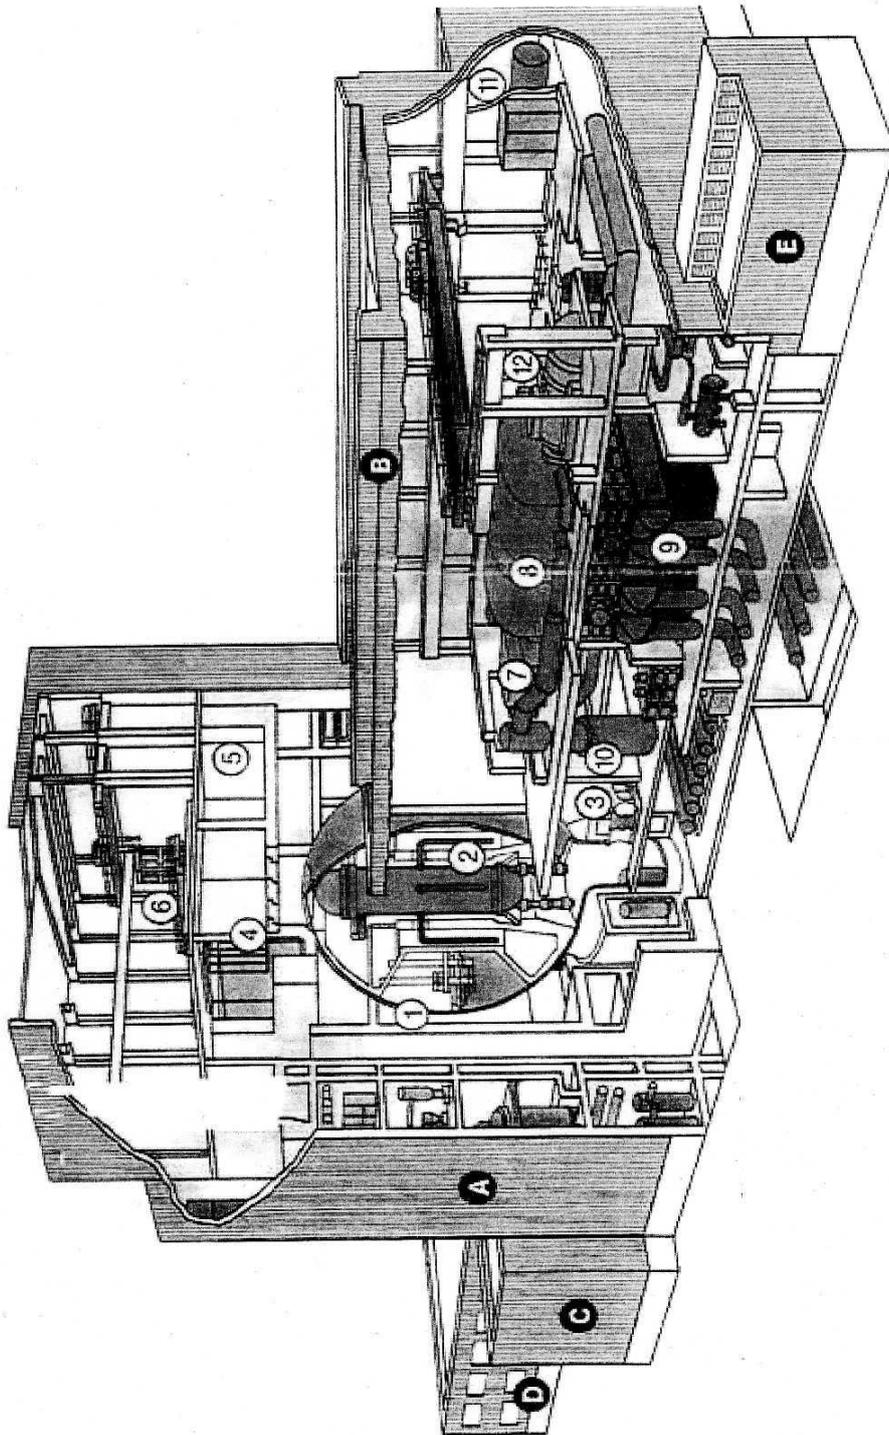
Innenausstattung der technischen Dimension<sup>155</sup>
